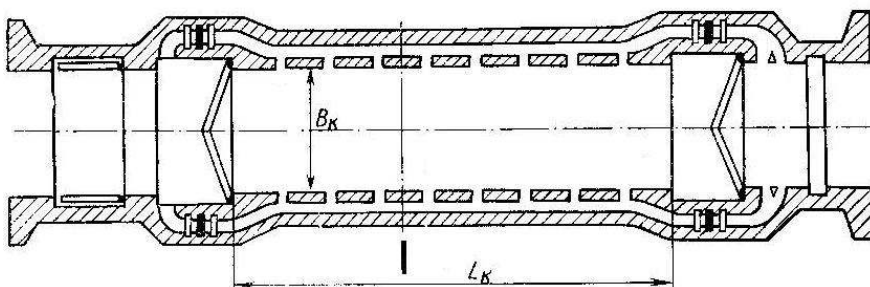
Продольная галерея с боковыми выпусками
